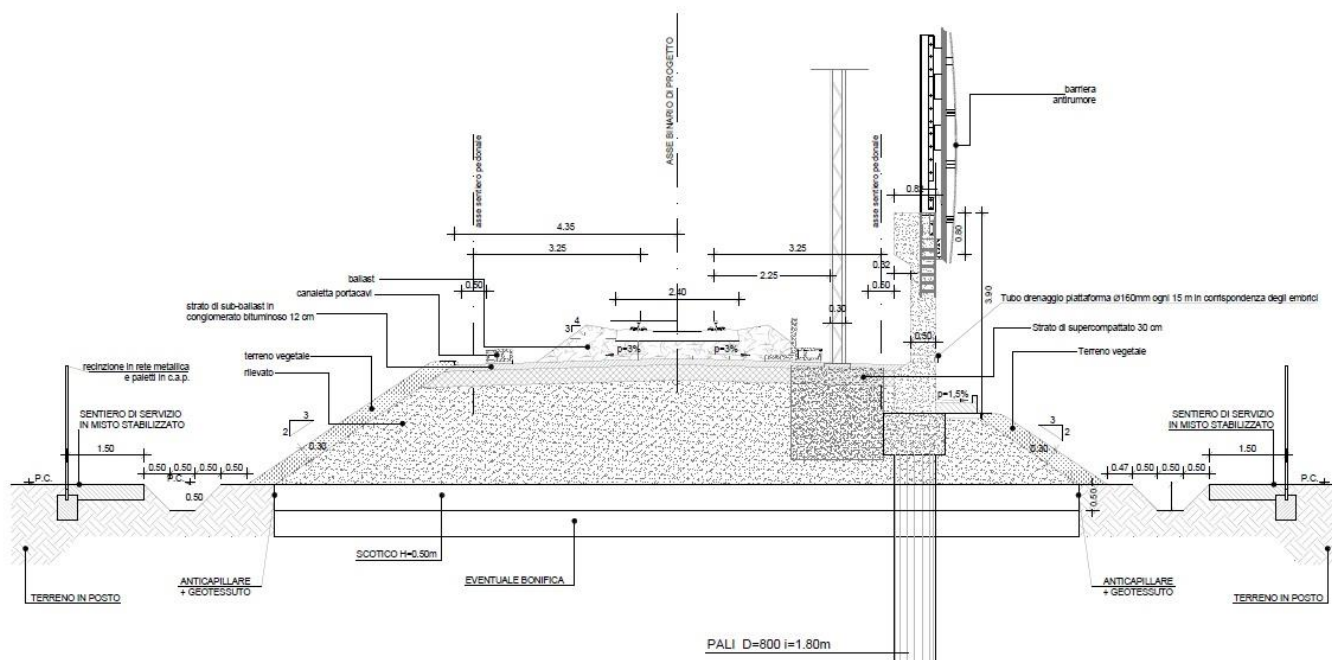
SEZIONE TIPO NUOVO TRATTO A SINGOLO BINARIO IN RILEVATO BRETELLA MERCI DI VIGNALE
